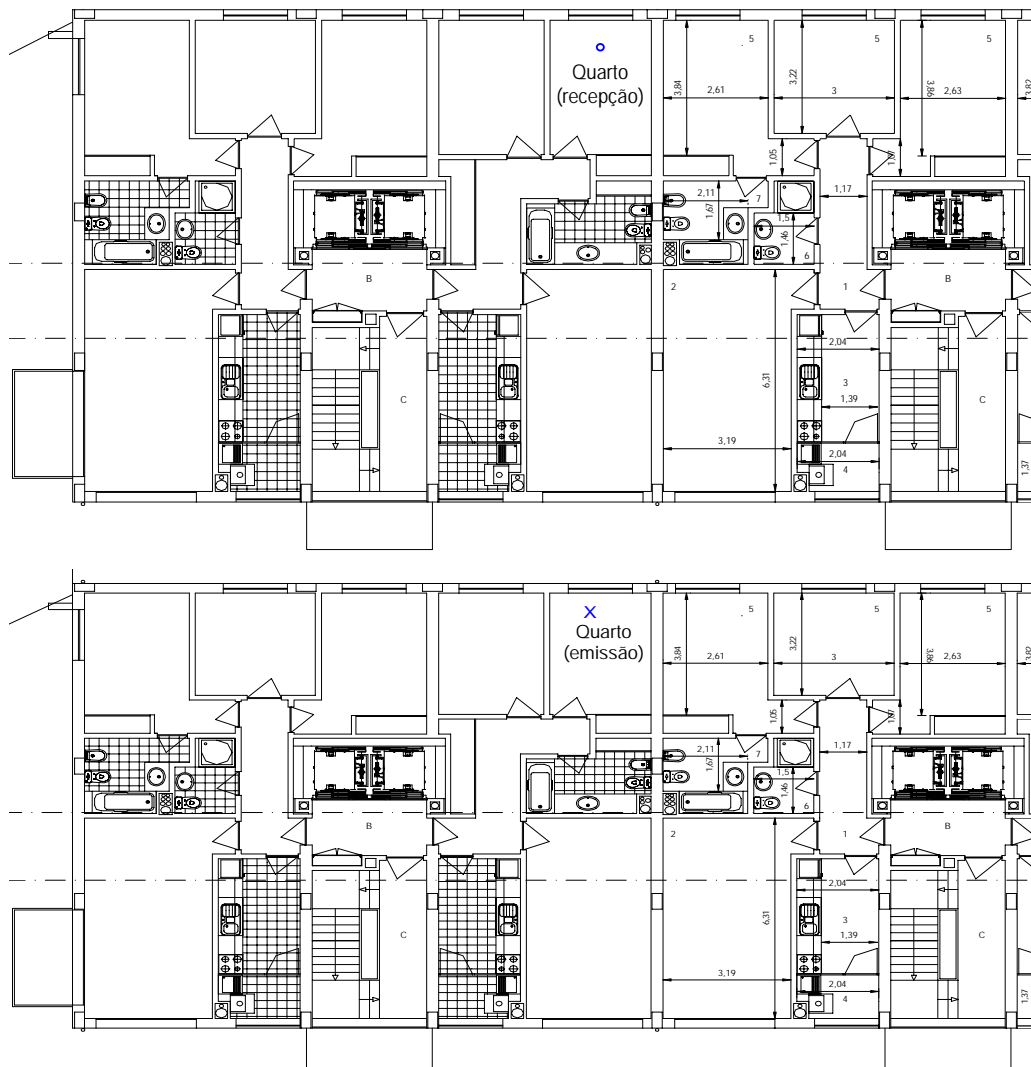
Planta do recinto emissor e do recinto receptor do ensaio de avaliação do isolamento do pavimento – Pav.14
